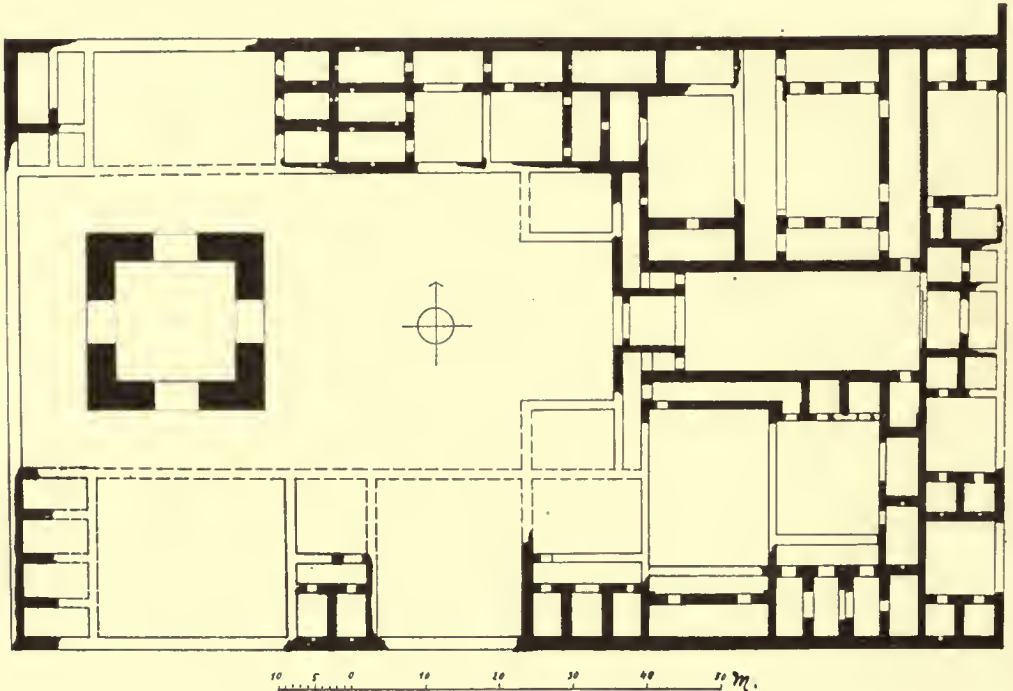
Tschehâr Kapu, Grundriß. Maßstab 1 : 1000.
